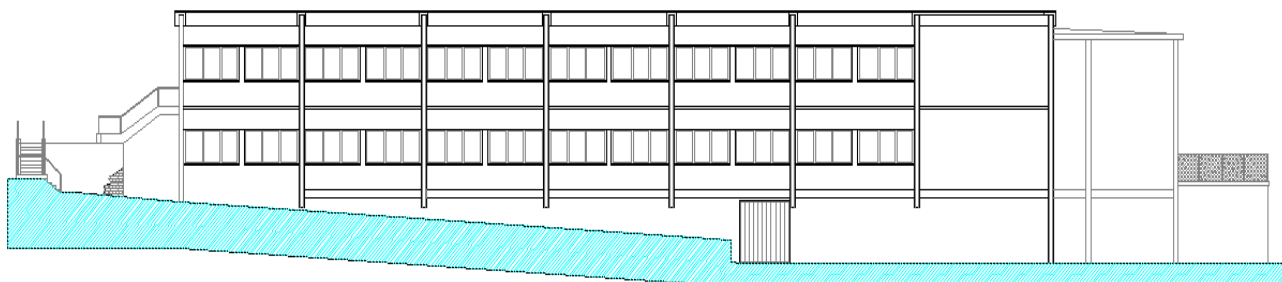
Prospetto sud – (disegno fornito dall'ing. A. Giardi)
